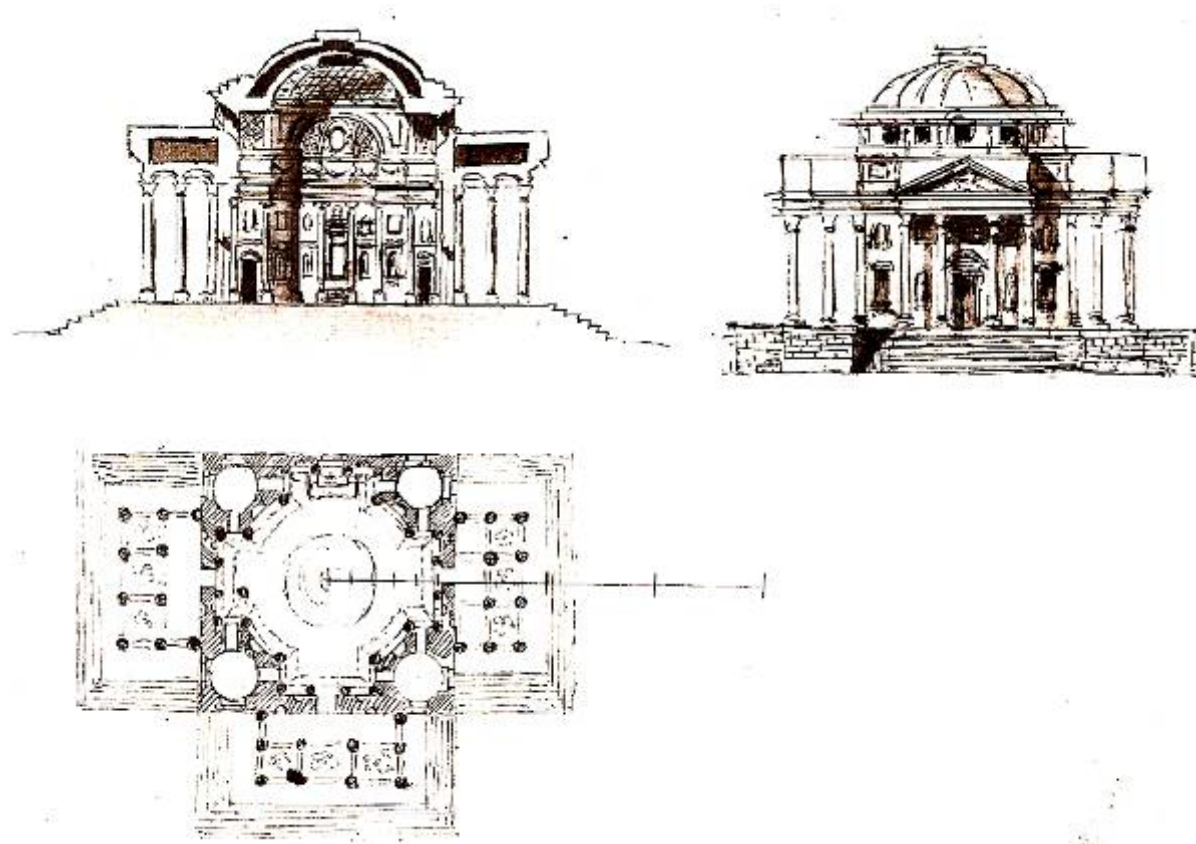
représentation d'ouvrage en deux dimensions : plan coupe et façade (dessin anonyme, collection particulière) [PER93]
